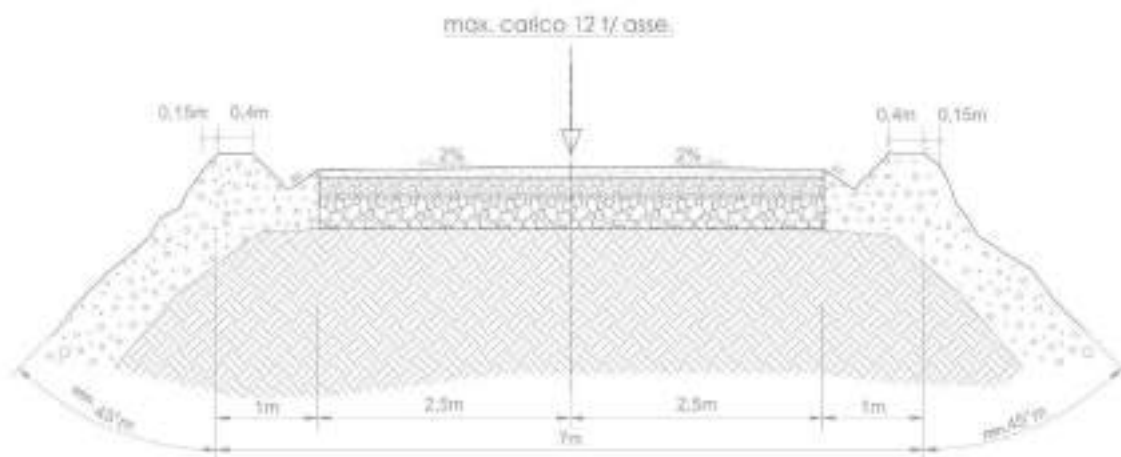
Sezione stradale tipo con doppia scarpata (in rilevato)
